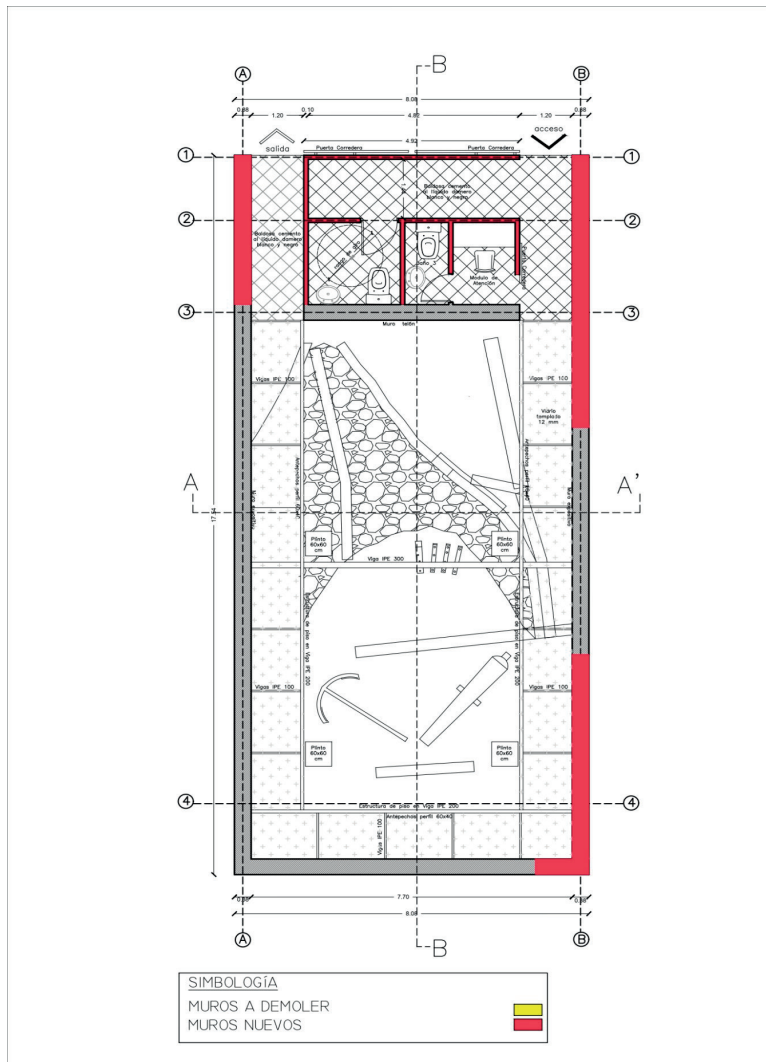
Planta de arquitectura nivel calle con propuesta de recorrido a través de rampa que considera accesibilidad universal.
